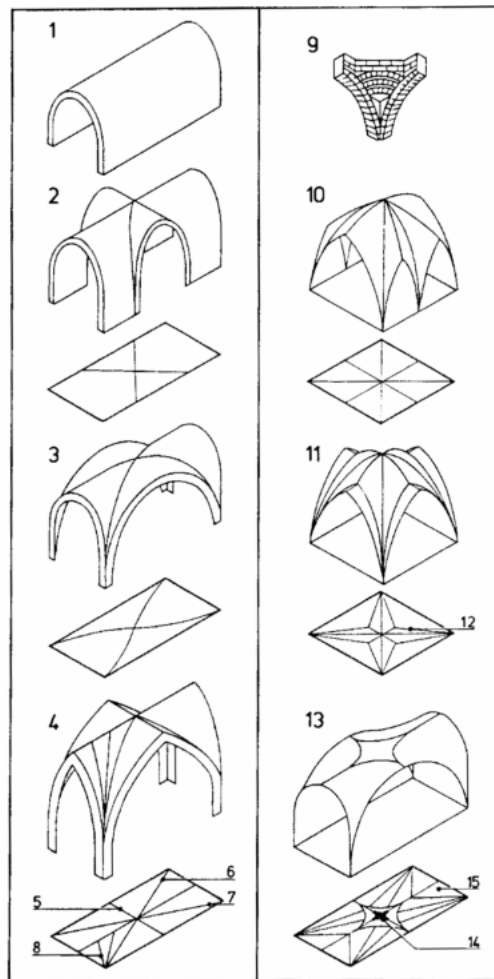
Конструкції зводів: 1-циліндричний (коробовий); 2- циліндричний з розпалубками; 3-хрестовий; 4-нервюрний (стрільчастий); 5-ліерна; 6-ожива; 7-поперечна замкова нервюра; 8-т'єрсерон; 9-парус; 10-шестидольний (шестилотковий); 11-зірчастий; 12-нервюра; 13-віяловий звод; 14-замковий камінь; 15-парус
